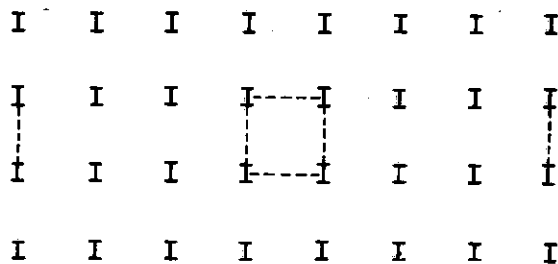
EDIFÍCIO EM PLANTA COM DISPOSIÇÃO DOS PAINÉIS CONTRAVENTADOS.
